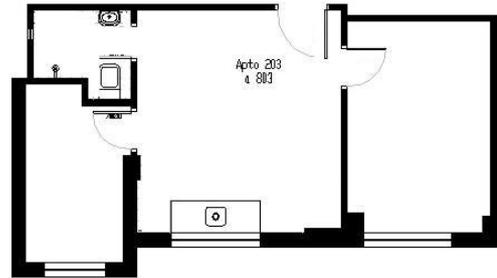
Planta-baixa da UH de um dormitório do empreendimento PAR 04
